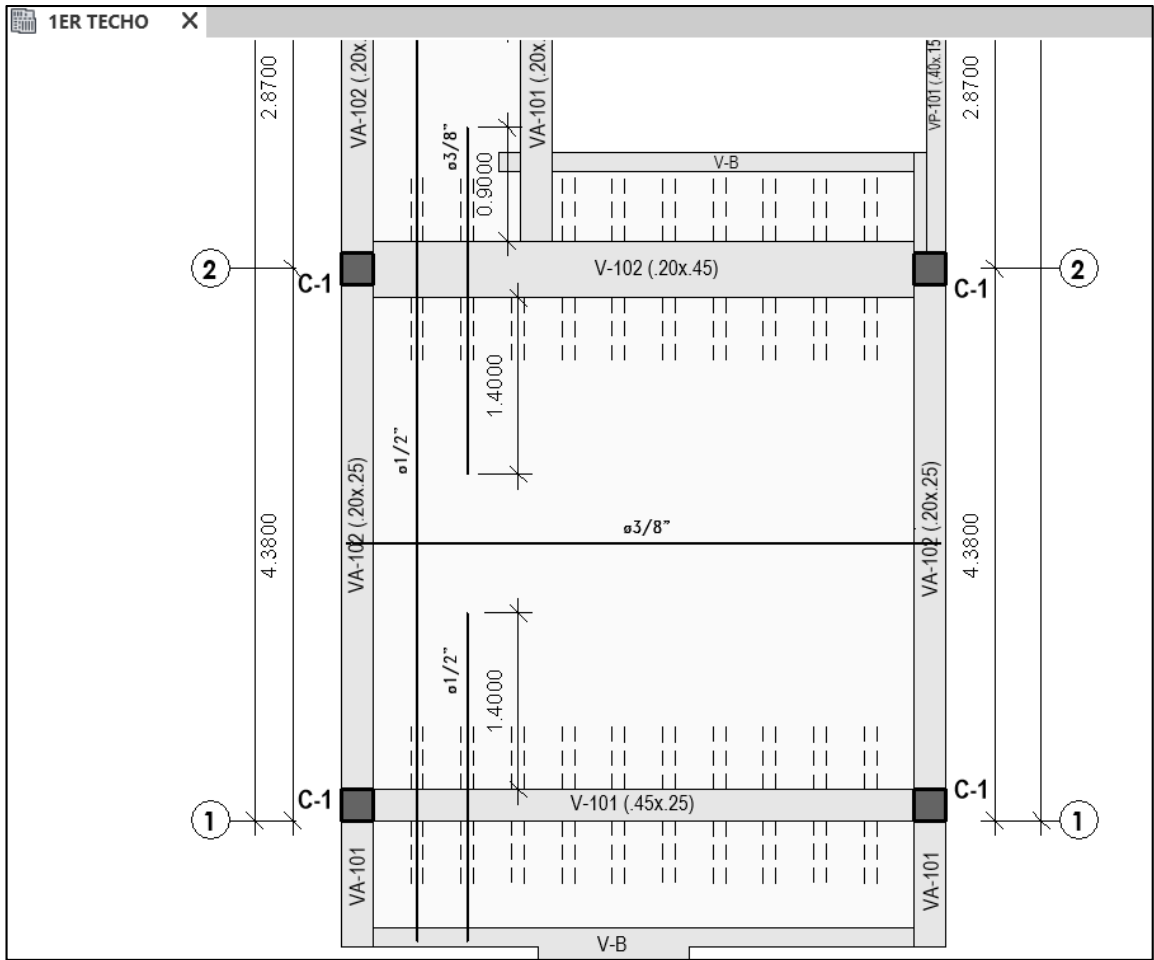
Vista 2D - Sección en Primer techo en BIM
